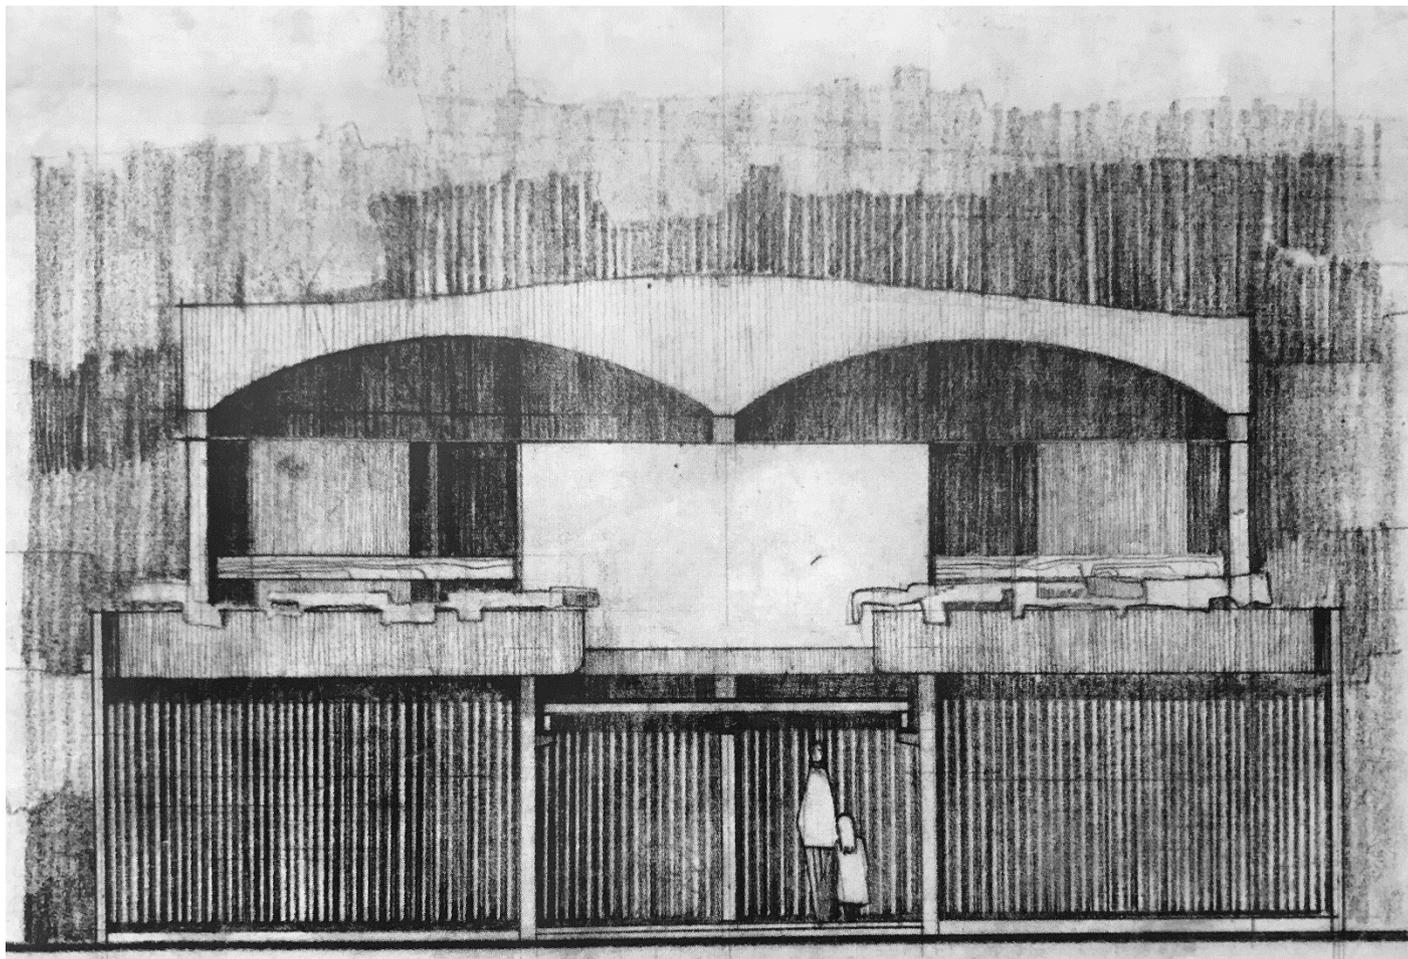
Ilustración de Fachada Original, Casa Jiguas
